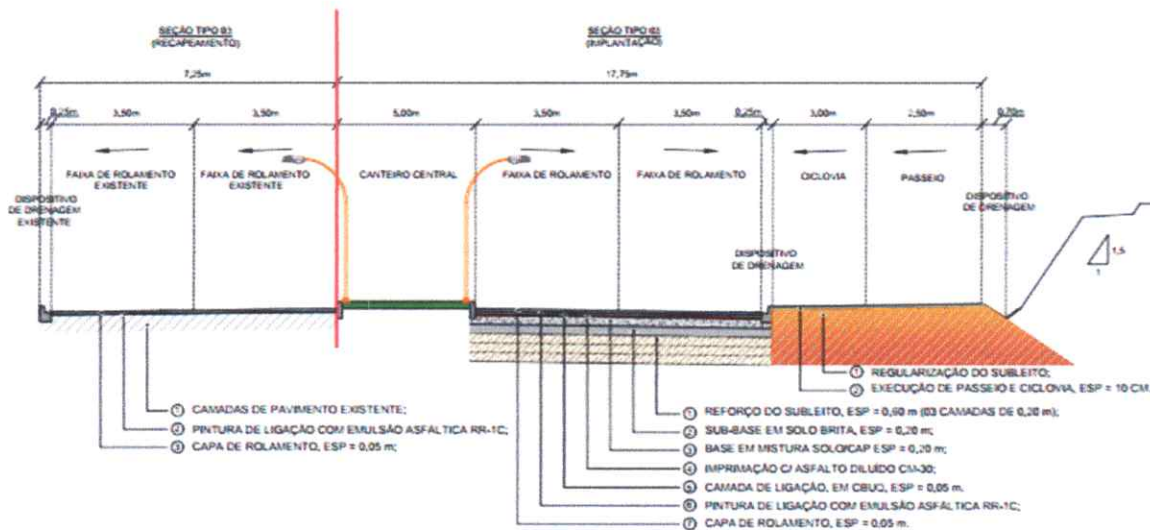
Via 02 – PB-042 (São Miguel de Taipu - Acesso Norte) – Seção Tipo 03
